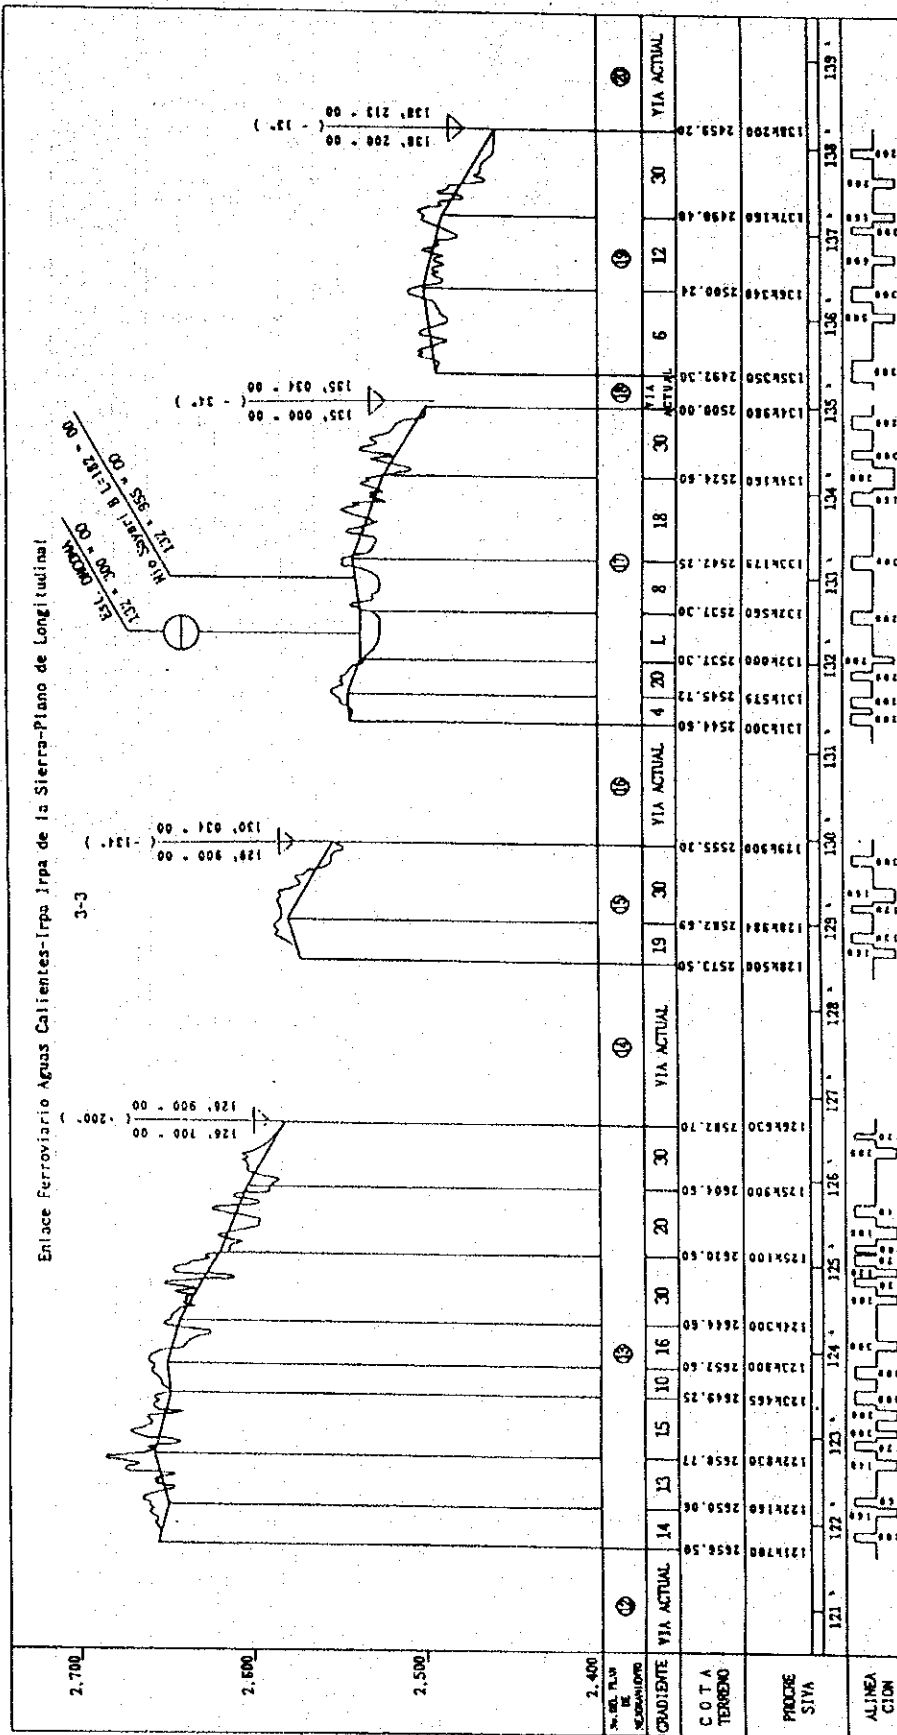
Perfil de Vía del Plan de Mejoramiento de la Ferrovia Oruro-Cochabamba; Plano 3 de 3
